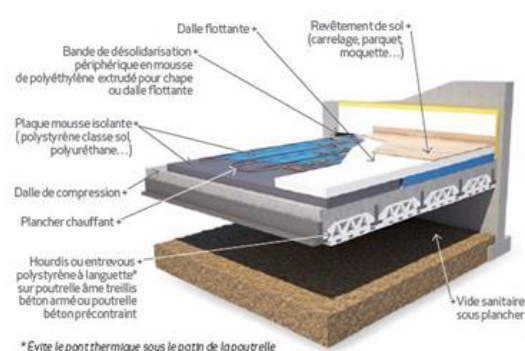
Schéma explicatif d'un dallage sur vide sanitaire (Gedimat).
